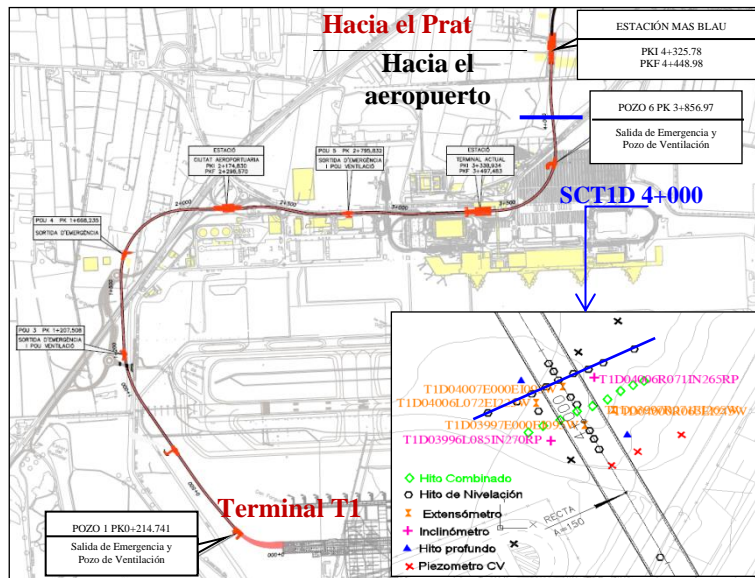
6. Posición en planta de la instrumentación y de la sección de control T1D PK 4+000 en el trazado de la Línea 9
